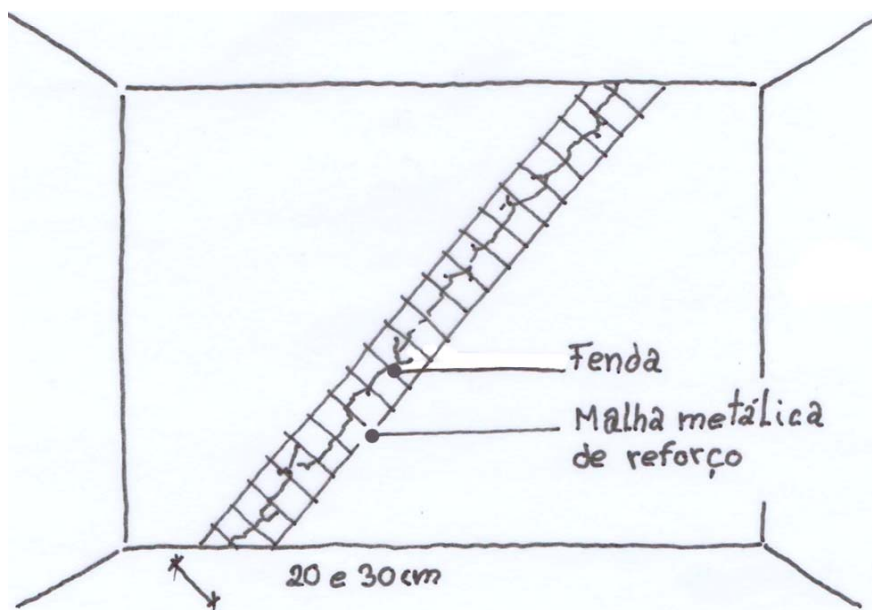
| Exemplo da reparação de uma fenda com a técnica de recobo armado (adaptado de [21])
